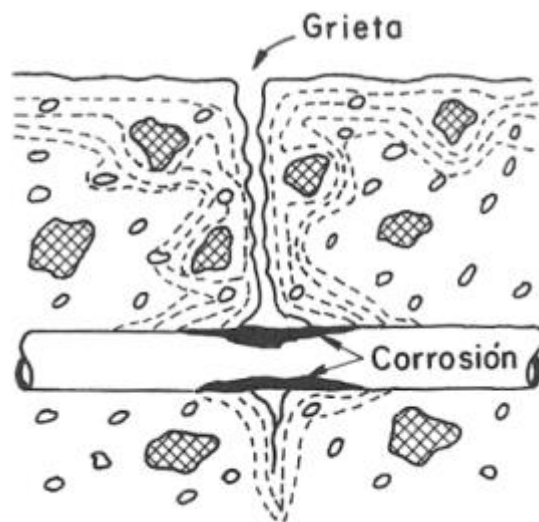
Fuerte corrosión de armaduras
